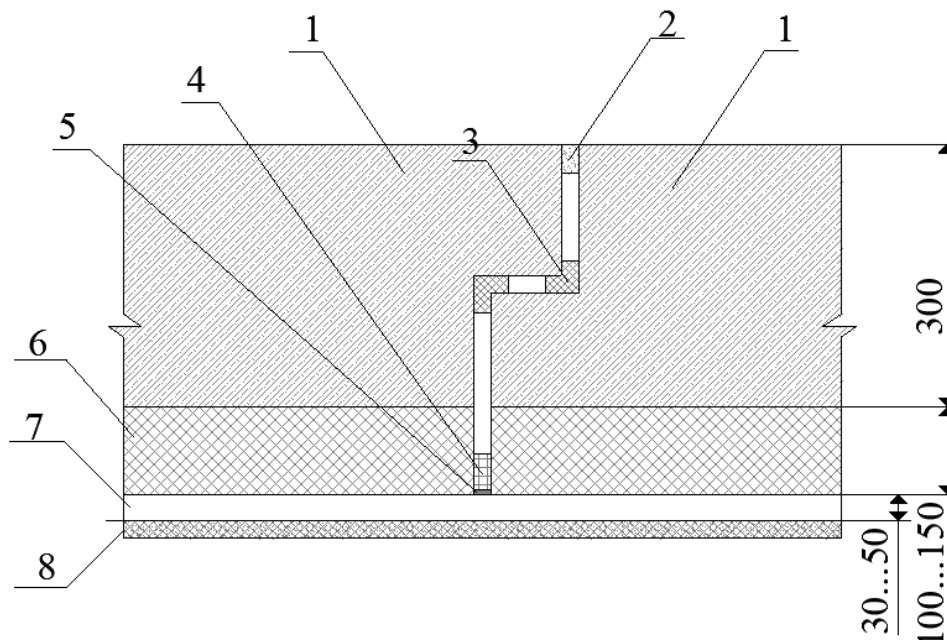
Схема зовнішнього утеплення одношарових стінових панелей системою вентилязованого фасаду: 1 – одношарова стінова панель; 2 – цементно-піщаний розчин; 3 – пружна прокладка; 4 – герметизаційна мастика; 5 – теплоізоляційний матеріал; 6 – вентиляований повітряний прошарок; 7 – опоряджувальні елементи.
